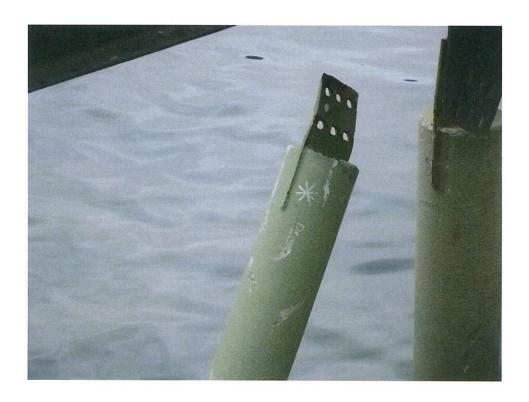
Deformación en las placas de conexión de los diagonales y no se encuentran alineadas con las vigas.
